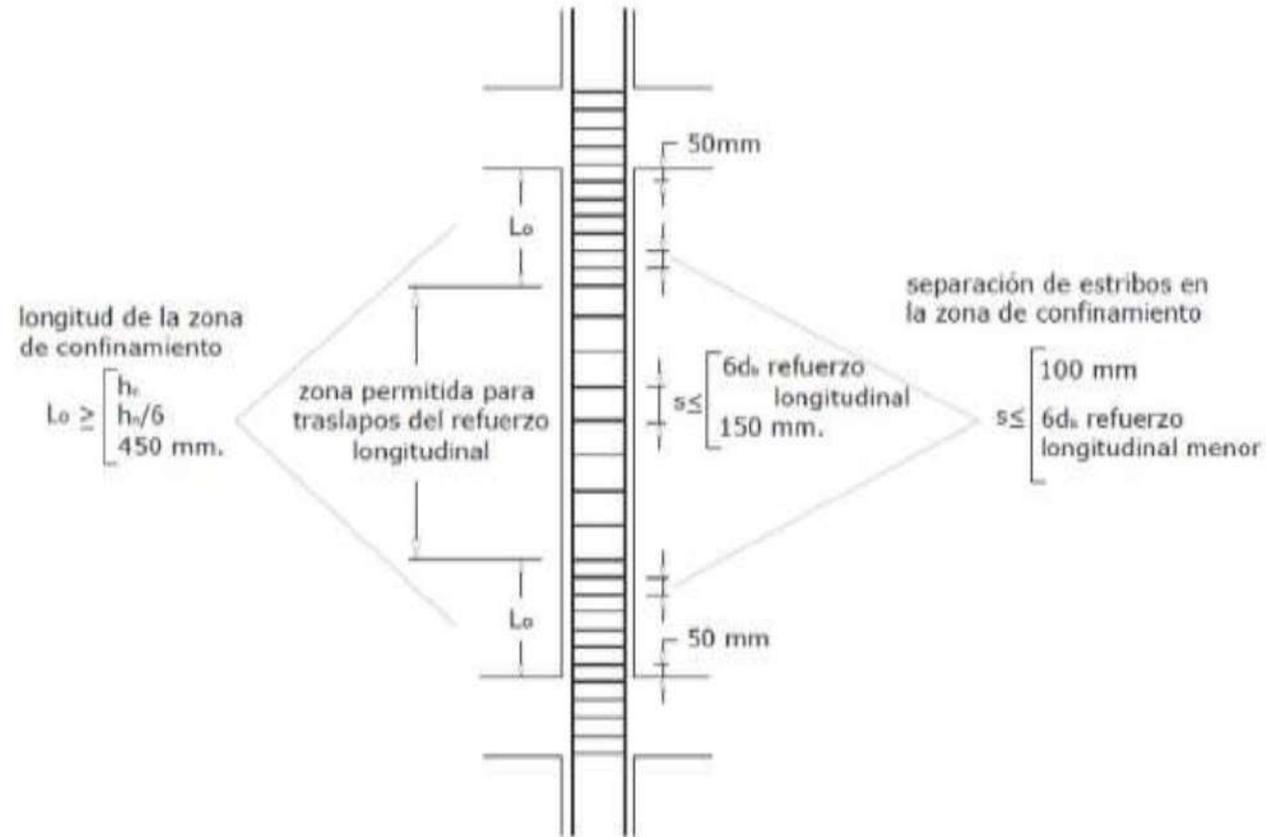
Separación de estribos en viviendas de más de 2 pisos o con luces mayores a 5m
